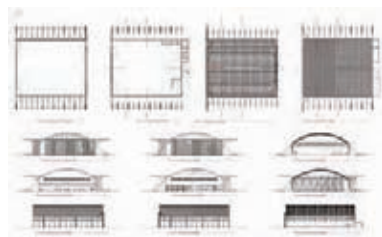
ARGIROFFI G., *Progetto di restauro, piante e sezioni delle aviorimesse
